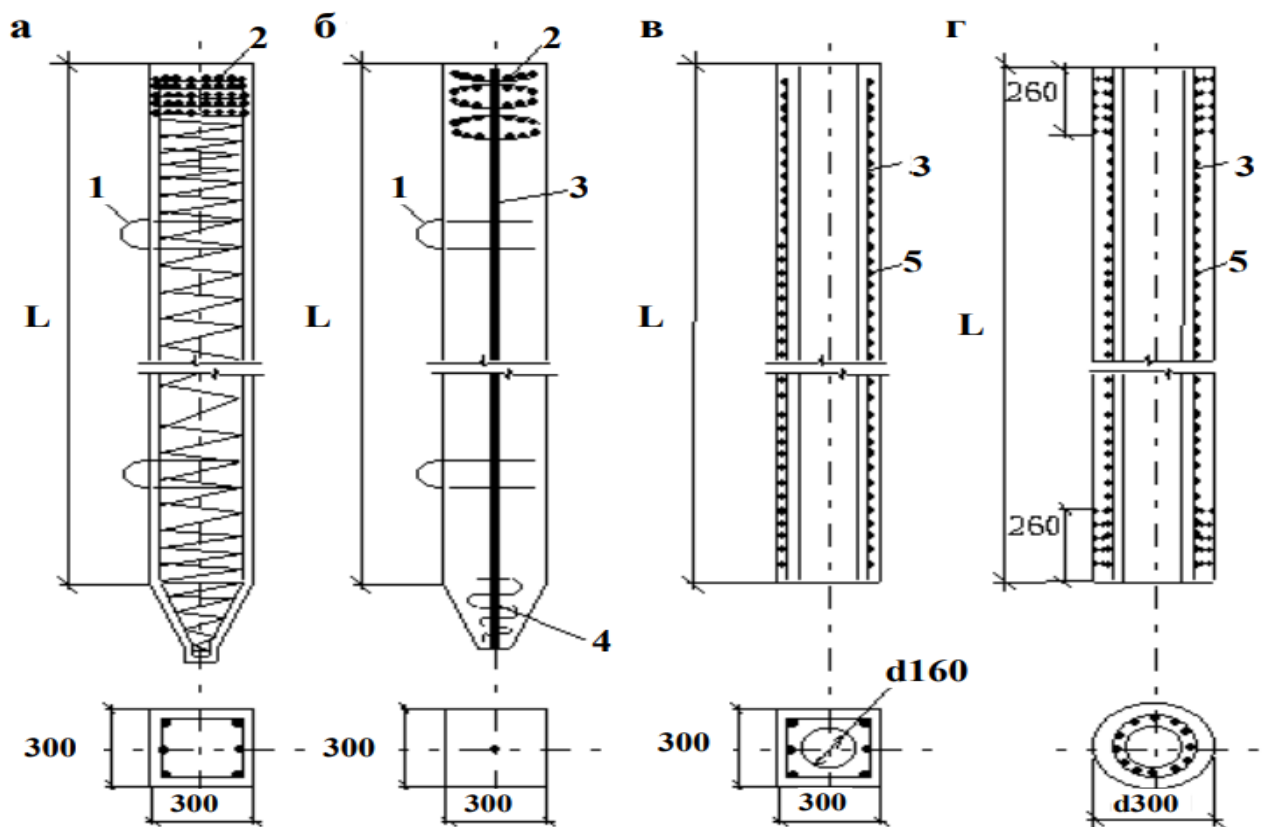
Конструкція і перетин залізобетонних палей: а – призматична з поперечним армуванням стовбура; б – те саме без поперечного армування стовбура; в – те саме з круглою порожниною; г – порожниста кругла: 1 – стропальна петля; 2 – арматурні сітки голови; 3 – повздовжня арматура; 4 – спіраль вістря; 5 – поперечна спіральна арматура
